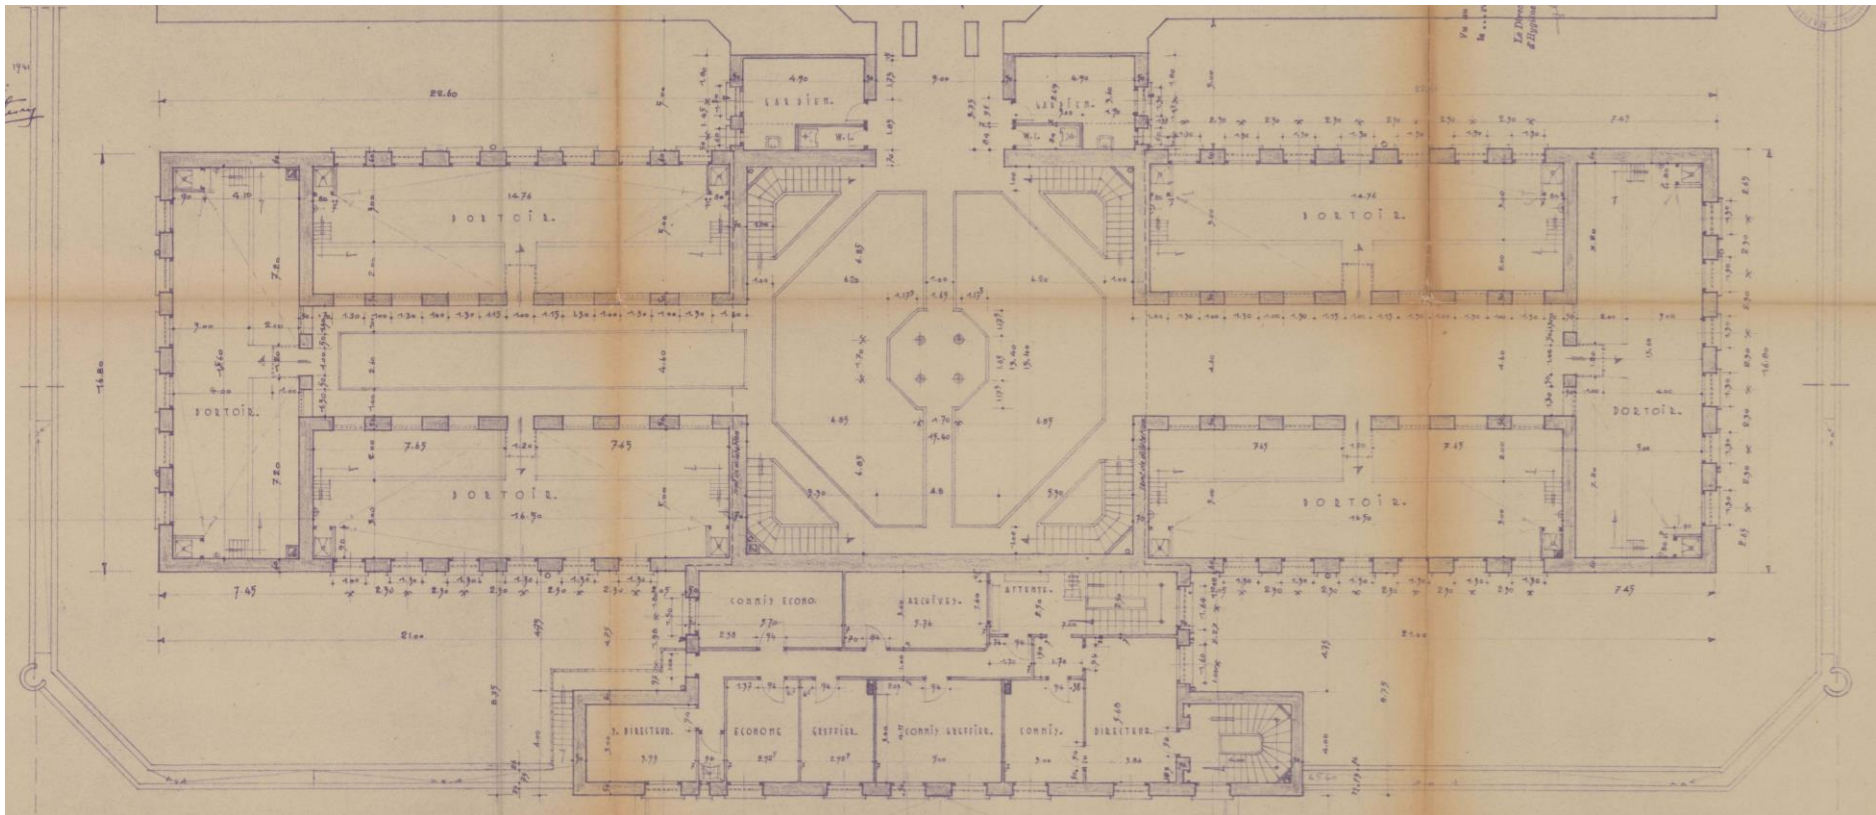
(2): L'extension du 1942, plan 2^{ème} étage.
